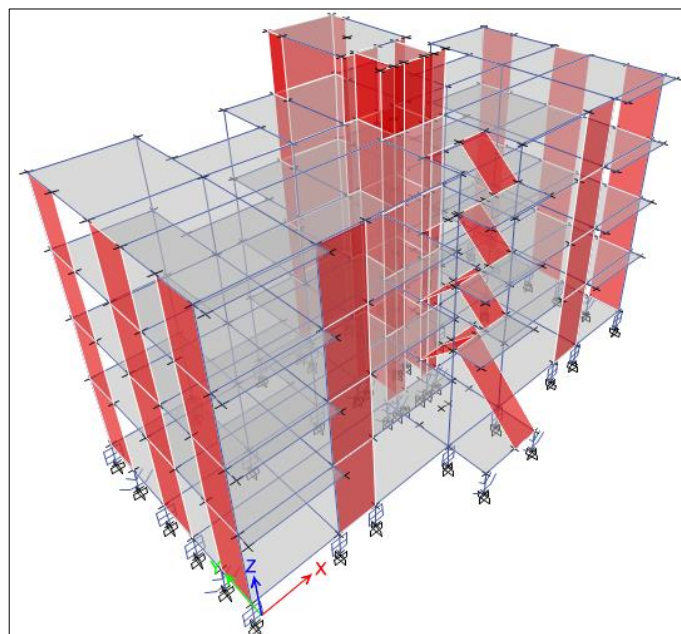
Vista conjunta frontal y lateral del modelo estructural 3D con aislamiento
